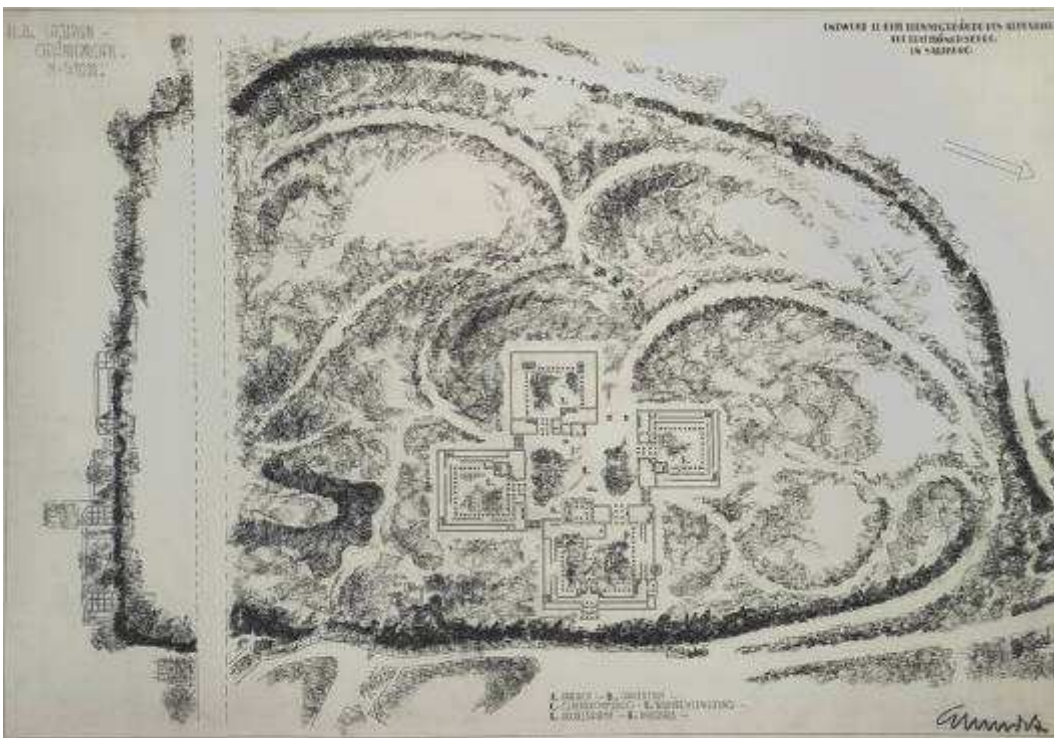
Alfons Schmidt, Bl. 8. *Lageplan – Geländeprofil, Entwurf zu dem Dienstgebäude des Alpenkorps auf dem Mönchsberg in Salzburg, April 1942 (SLA, HBA, IX 01).
